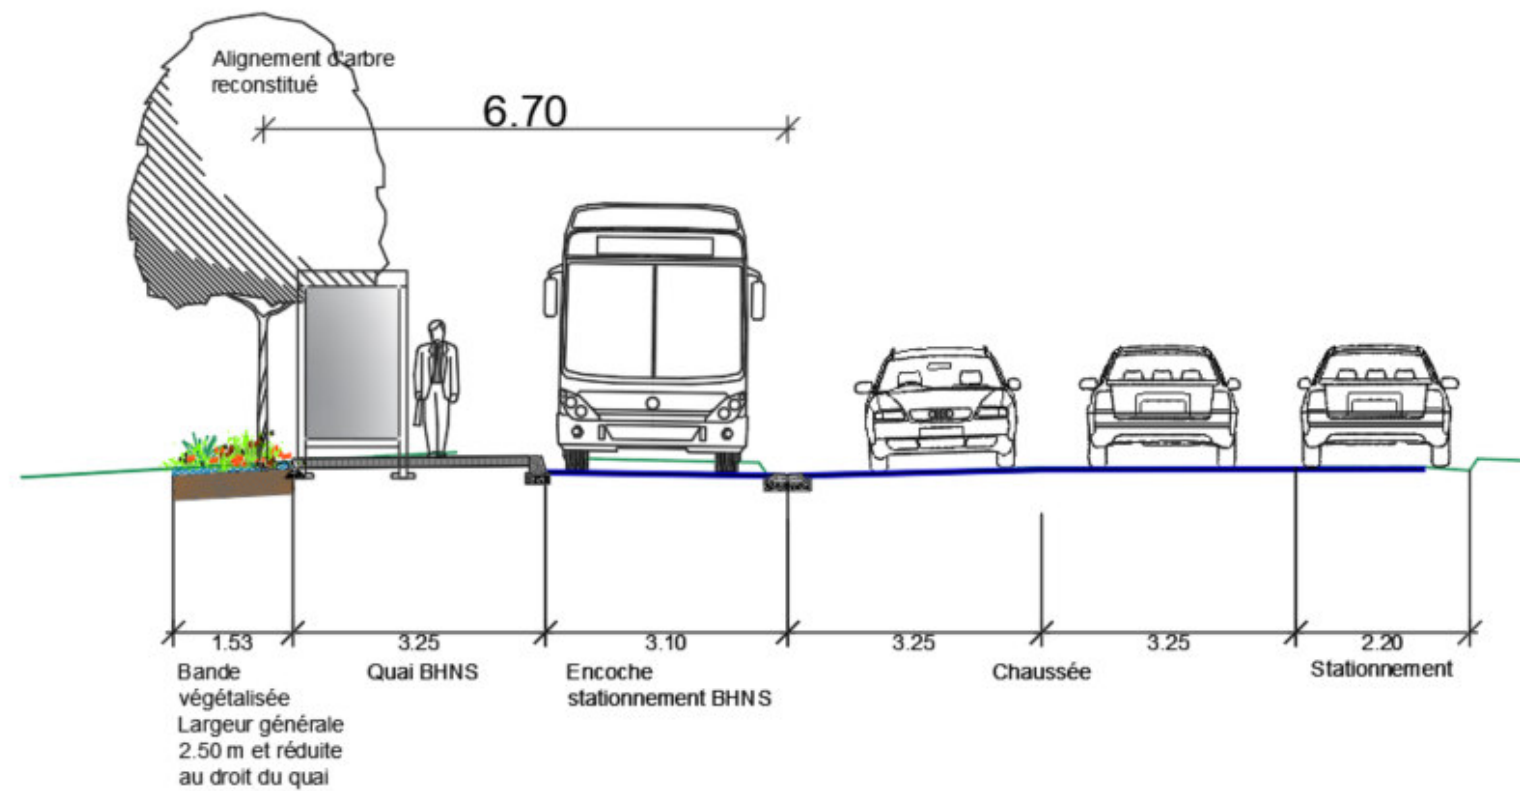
Coupe transversale de l'état projeté au droit de l'alignement d'arbres impacté
